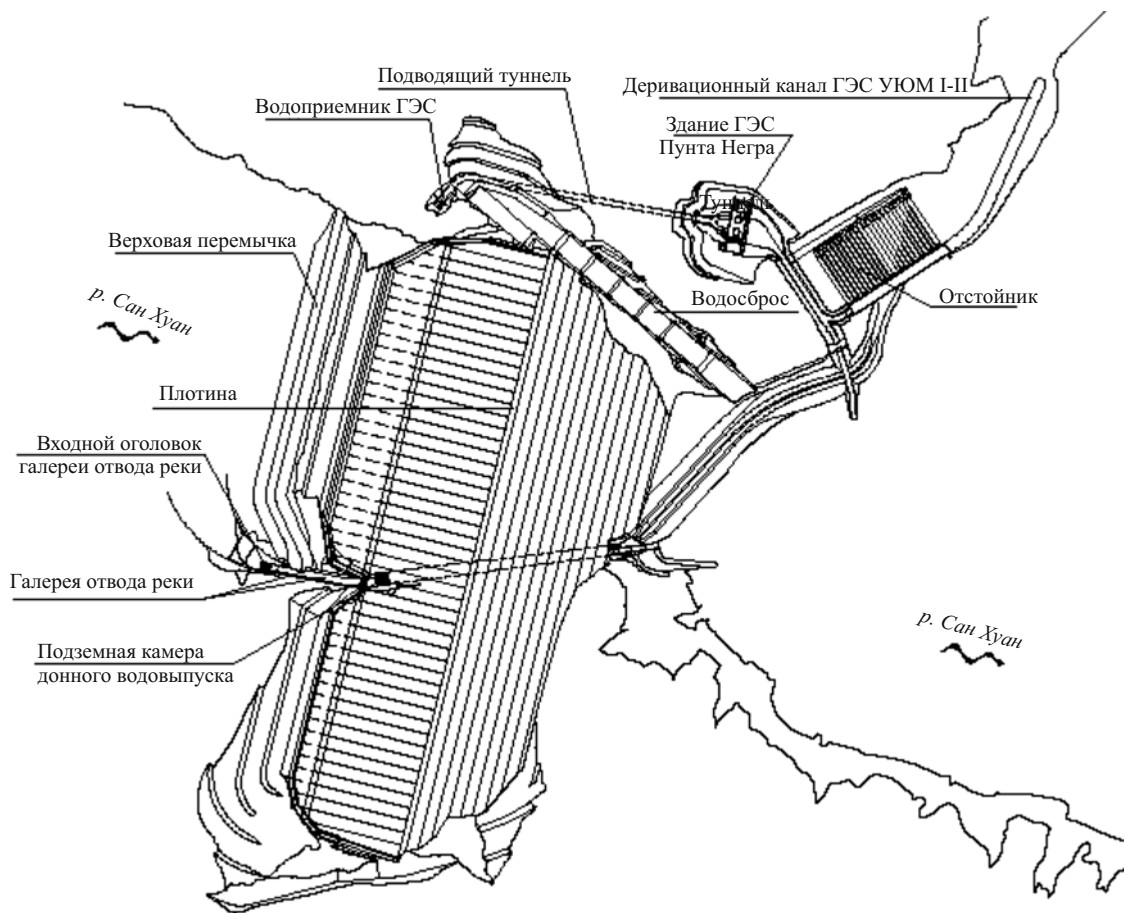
План гидроузла Пунта-Негра, оптимизированный проект
